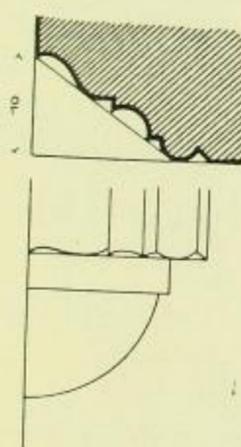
Türprofil im zweiten Obergeschoß, Schloß, Hauptgebäude.
